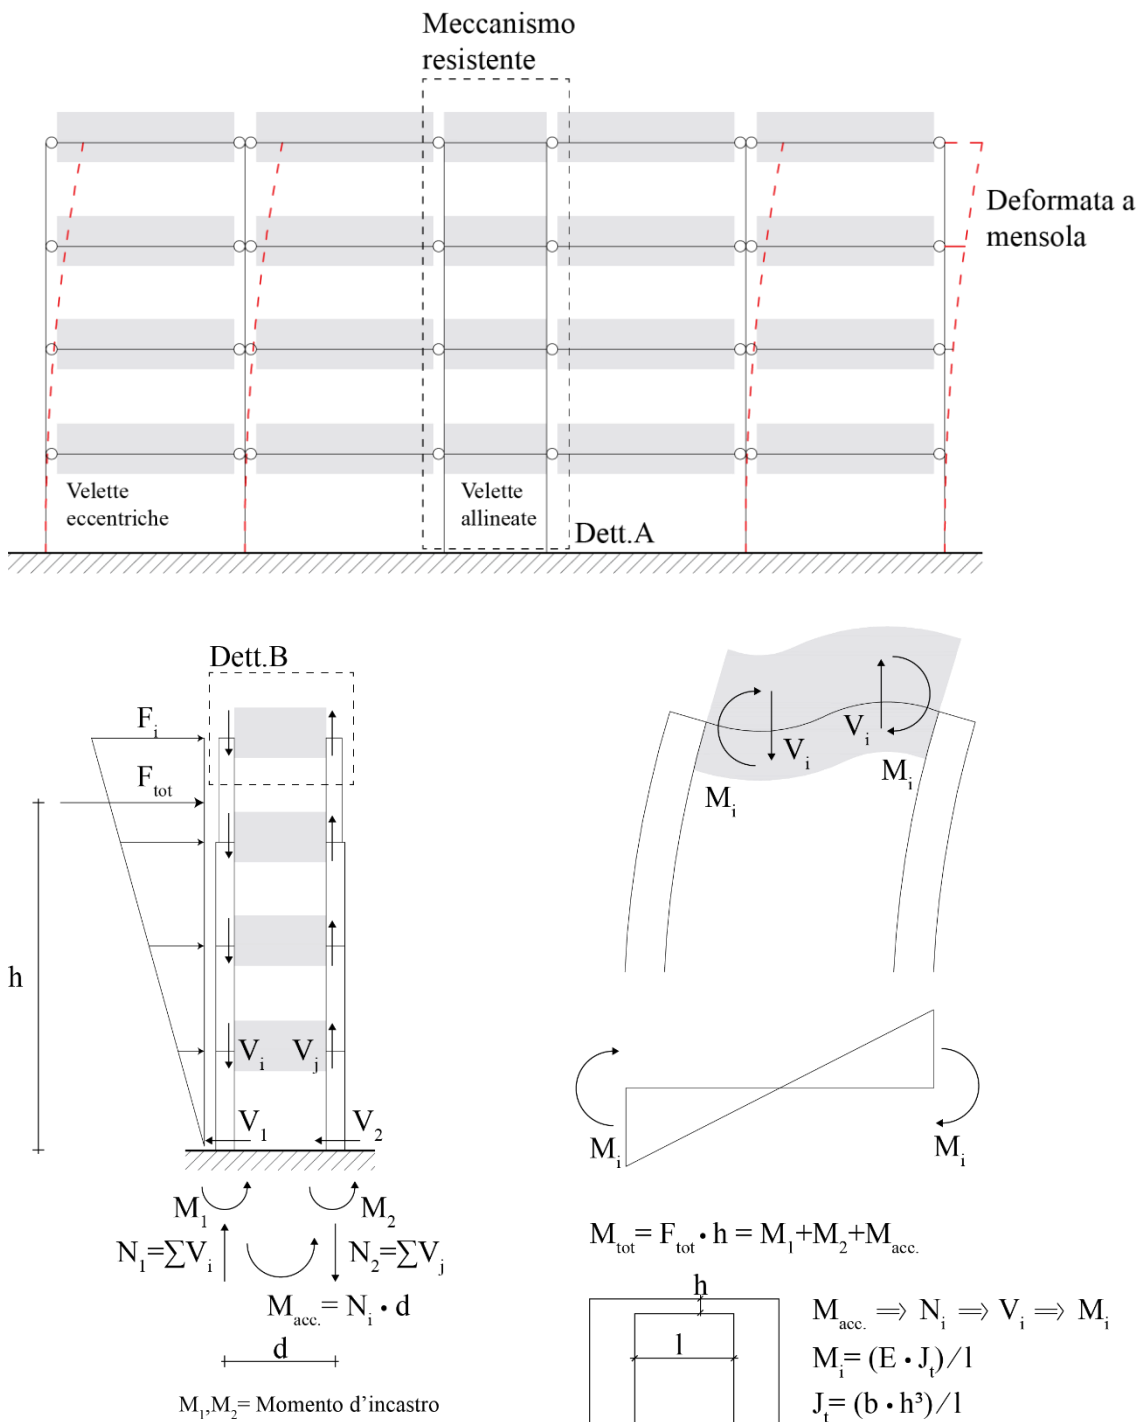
a) Dettaglio A meccanismo resistente che sollecita a trazione-compressione i pilastri dei telai in dir. C-D, b) Dettaglio B azioni trasmesse dai pilastri alle velette di collegamento.
